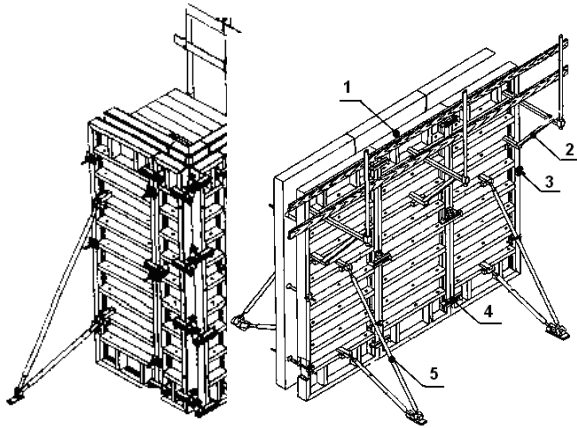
Схеми опалубки вертикальних конструкцій будівлі.
